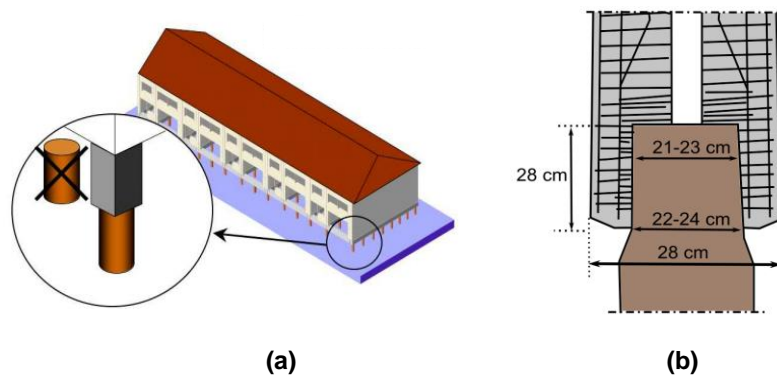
Connexion entre les fondations et la partie supérieure du bâtiment (a) - Dé en béton renforcé par des armatures métalliques en tête des pieux (b) ([Stichting Platform Fundering Nederland, 2005 et 2007](#))
